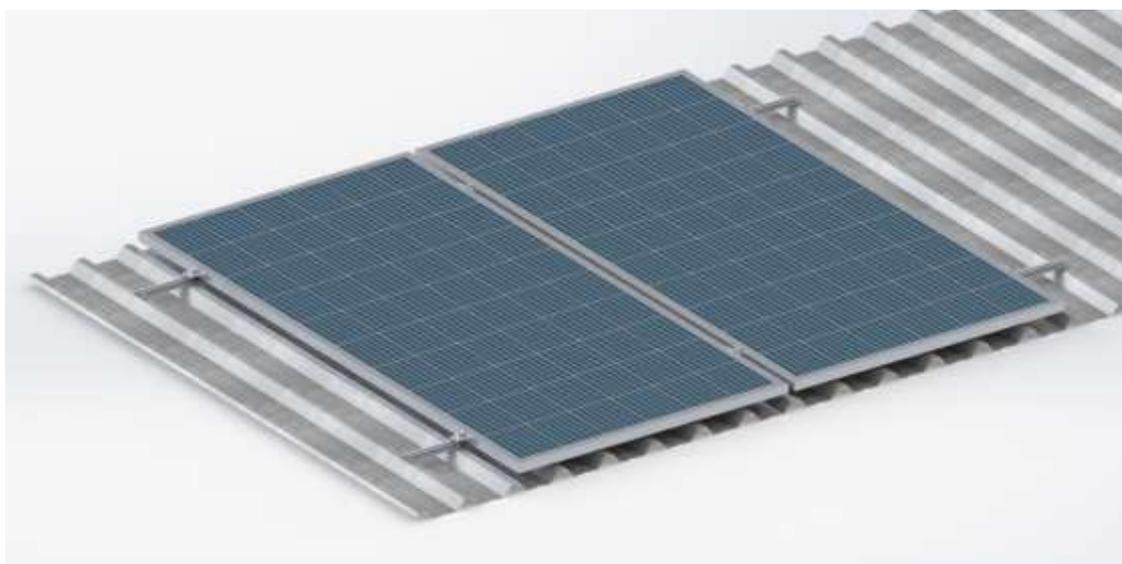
Montagem do Suporte de Fixação para Telhado Trapezoidal Perfil Direto para 2 Módulos – Com os módulos
